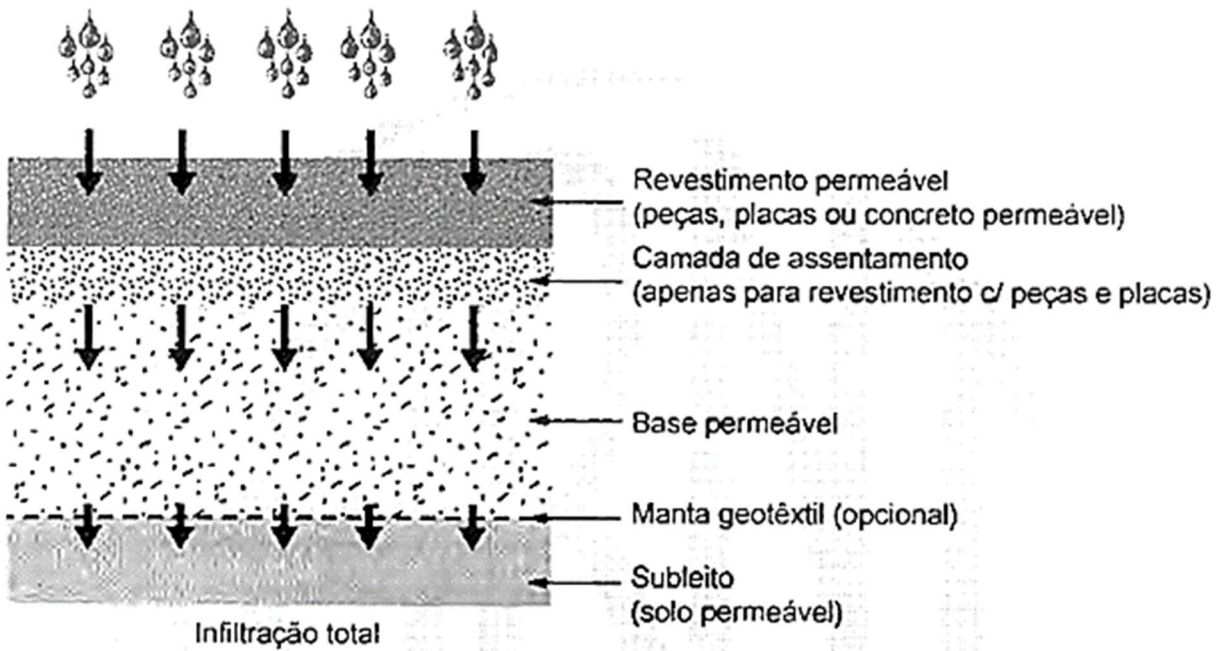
Exemplo de sistema de pavimento permeável com infiltração total
